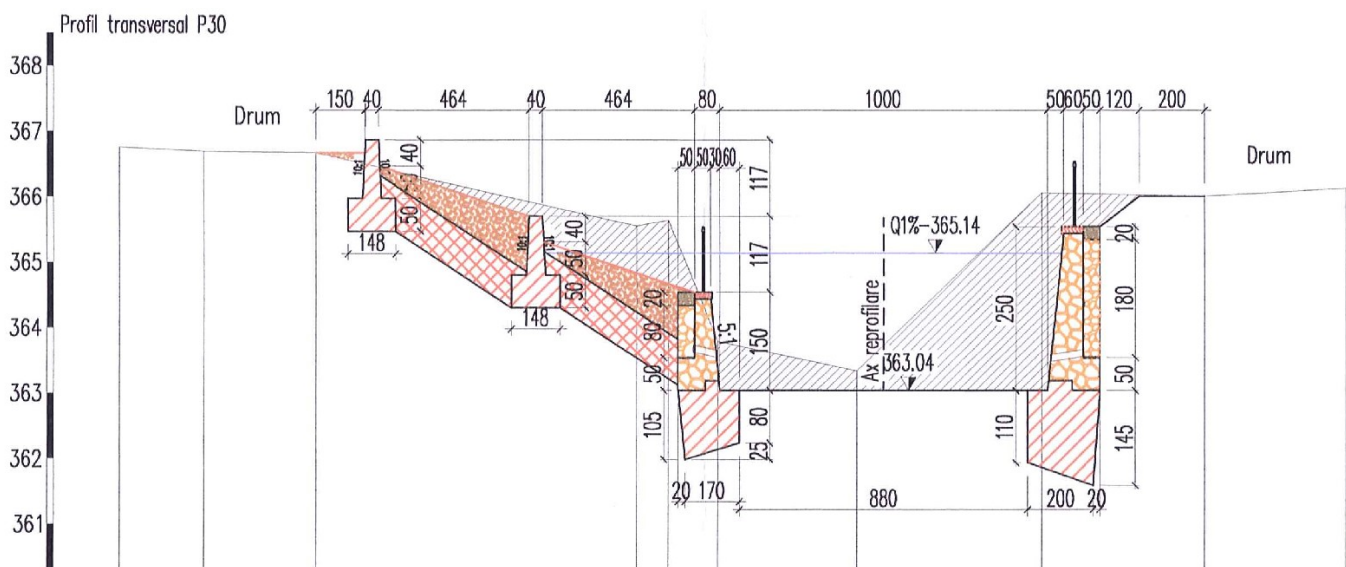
Profil transversal cu ST3 Parapet din beton și ST3.1 Grindă pentru stabilizare parapet din beton
